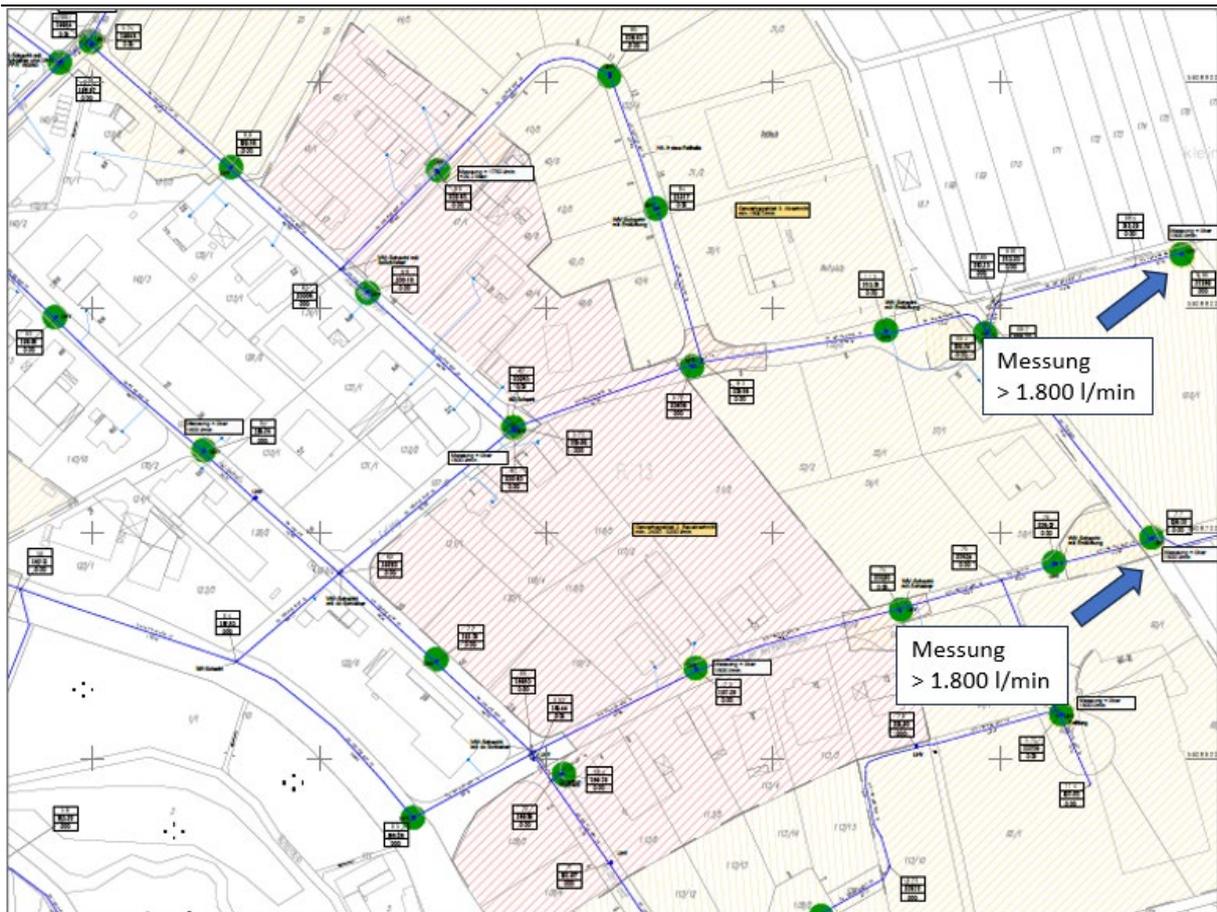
Lageplan Hydranten - Messung; Quelle: Best Ingenieure
